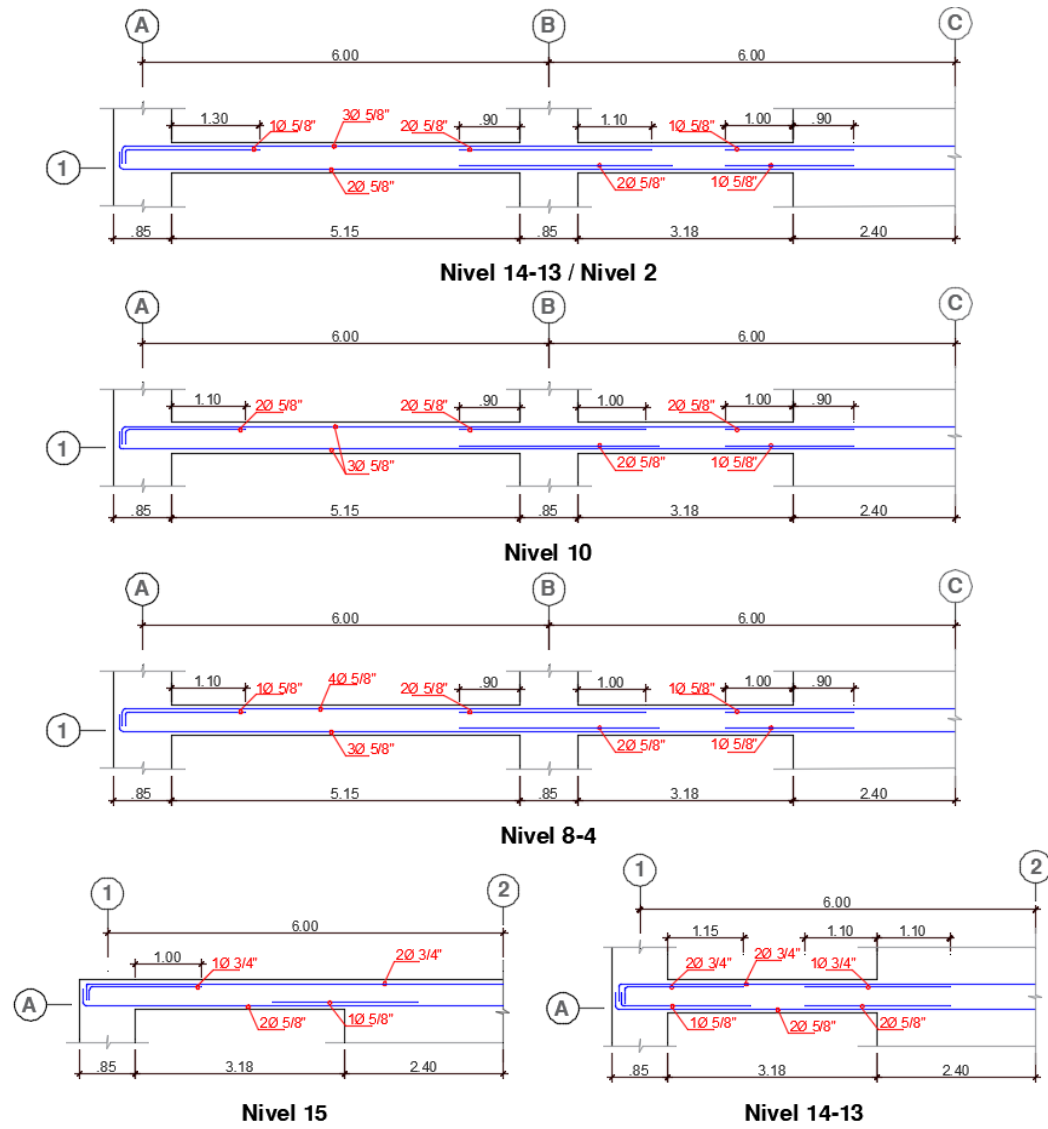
Refuerzo requerido por flexo-tracción en las vigas para el edificio Edi-15 (Continuación)
